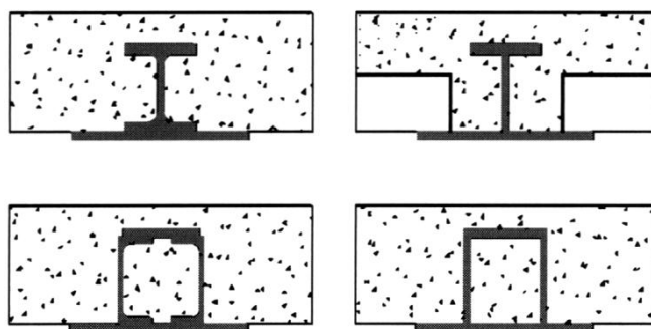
Сечения сталежелезобетонных плит с жесткой арматурой с необетонированной нижней полкой [11]
